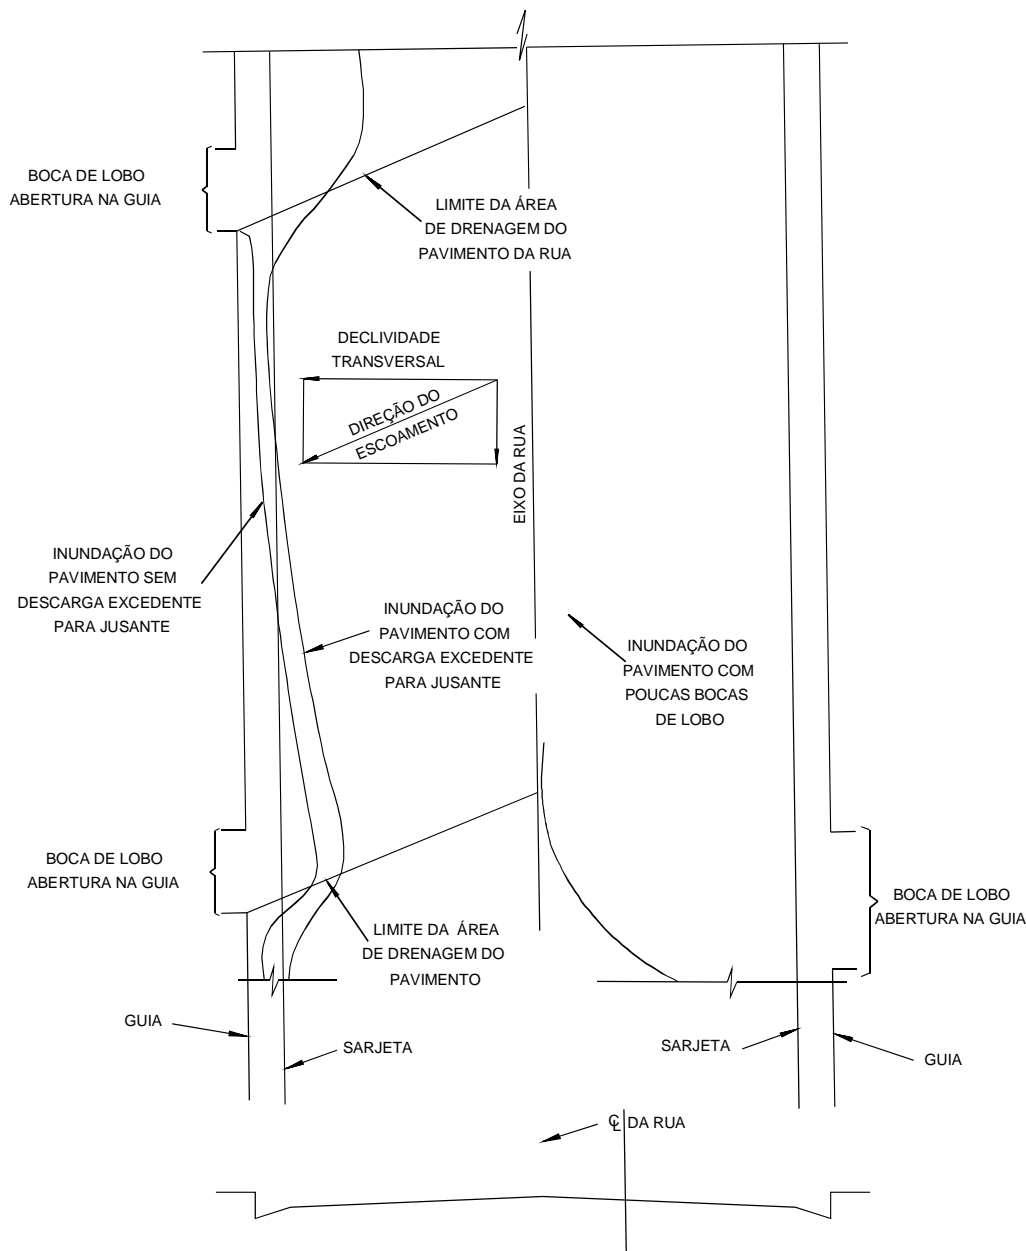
Diagrama de configurações de escoamento no pavimento e na sarjeta.
